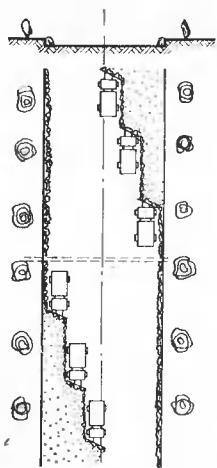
Схема уборки снега с улицы с двусторонним движением
